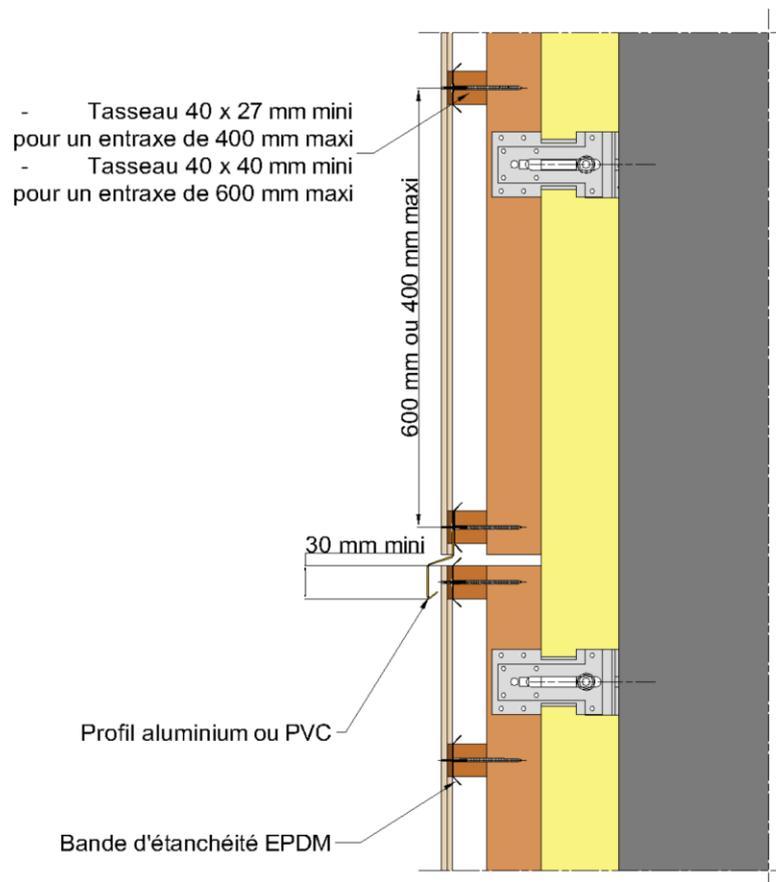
Fractionnement de l'ossature – pose verticale des lames CEDRAL LAP
